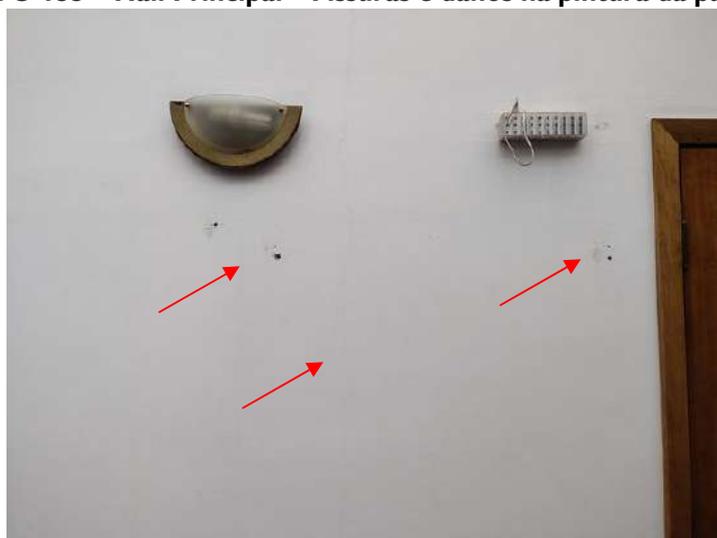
Hall Principal – Fissuras e danos na pintura da parede
